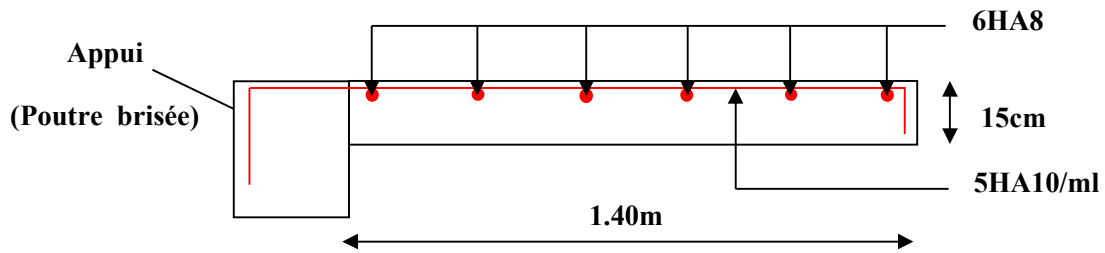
Schéma de ferrailage de la partie 2 de l'escalier.
